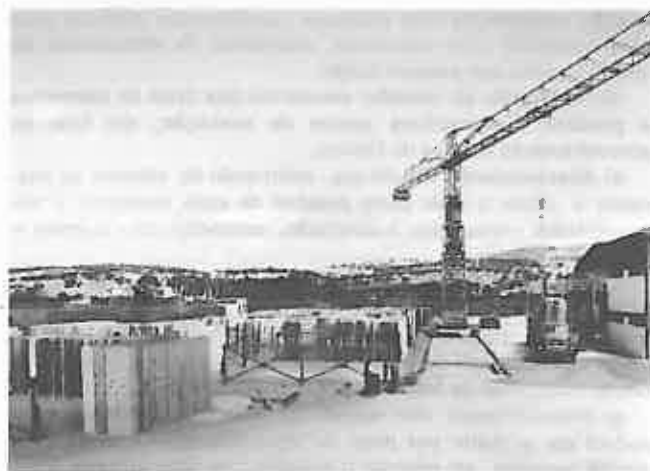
Parque de armazenamento de elementos de pavimento; ao fundo, vista exterior da fábrica de elementos.
